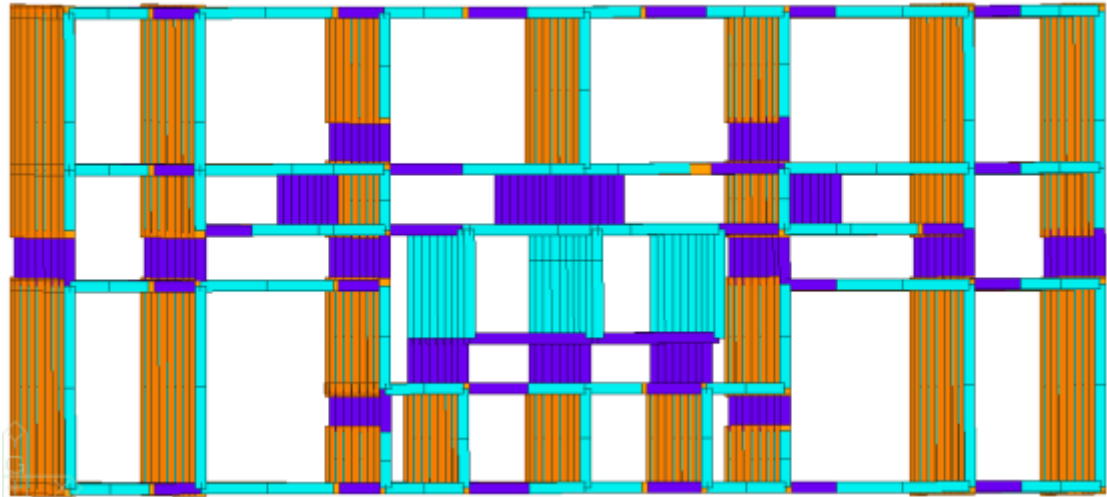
Vista en planta del desplazamiento debido al sismo en dirección X
